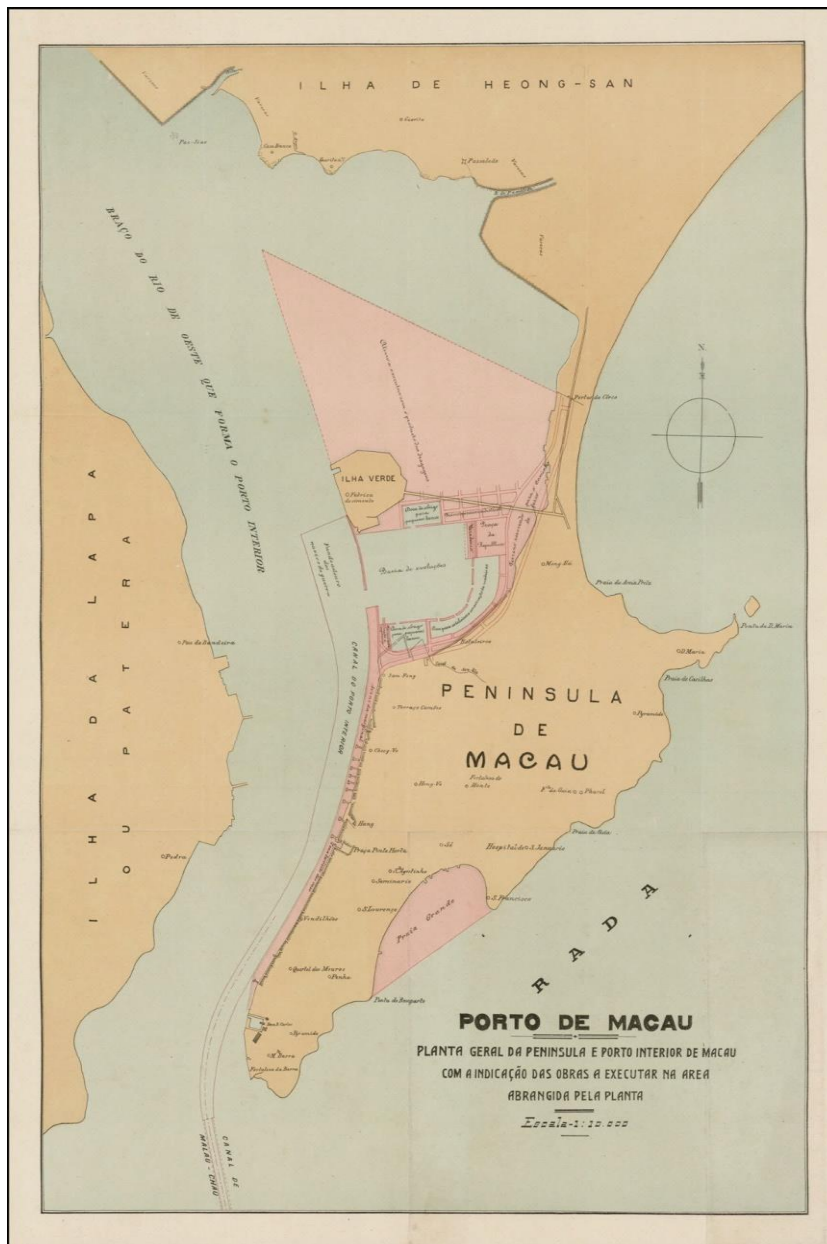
Planta Geral da Península e Porto Interior de Macau com a Indicação das Obras a Executar na Área Abrangida pela Planta.
